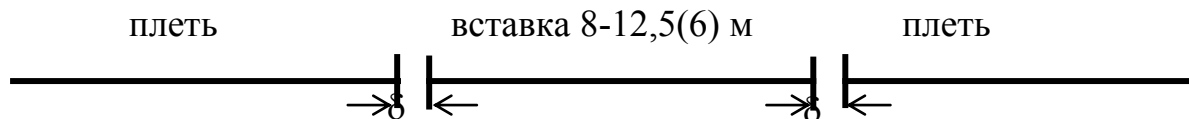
Схема алюминотермитной сварки рельсовой вставки с концами плети после вырезки рельса с дефектом
